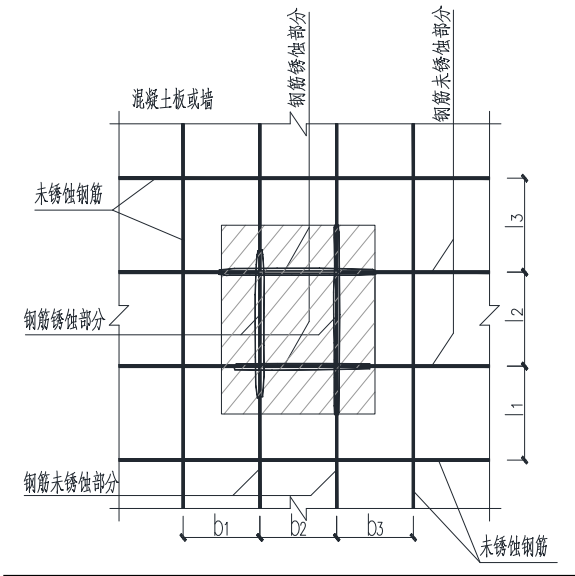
墙（板）单处钢筋锈蚀面积计算示意图
